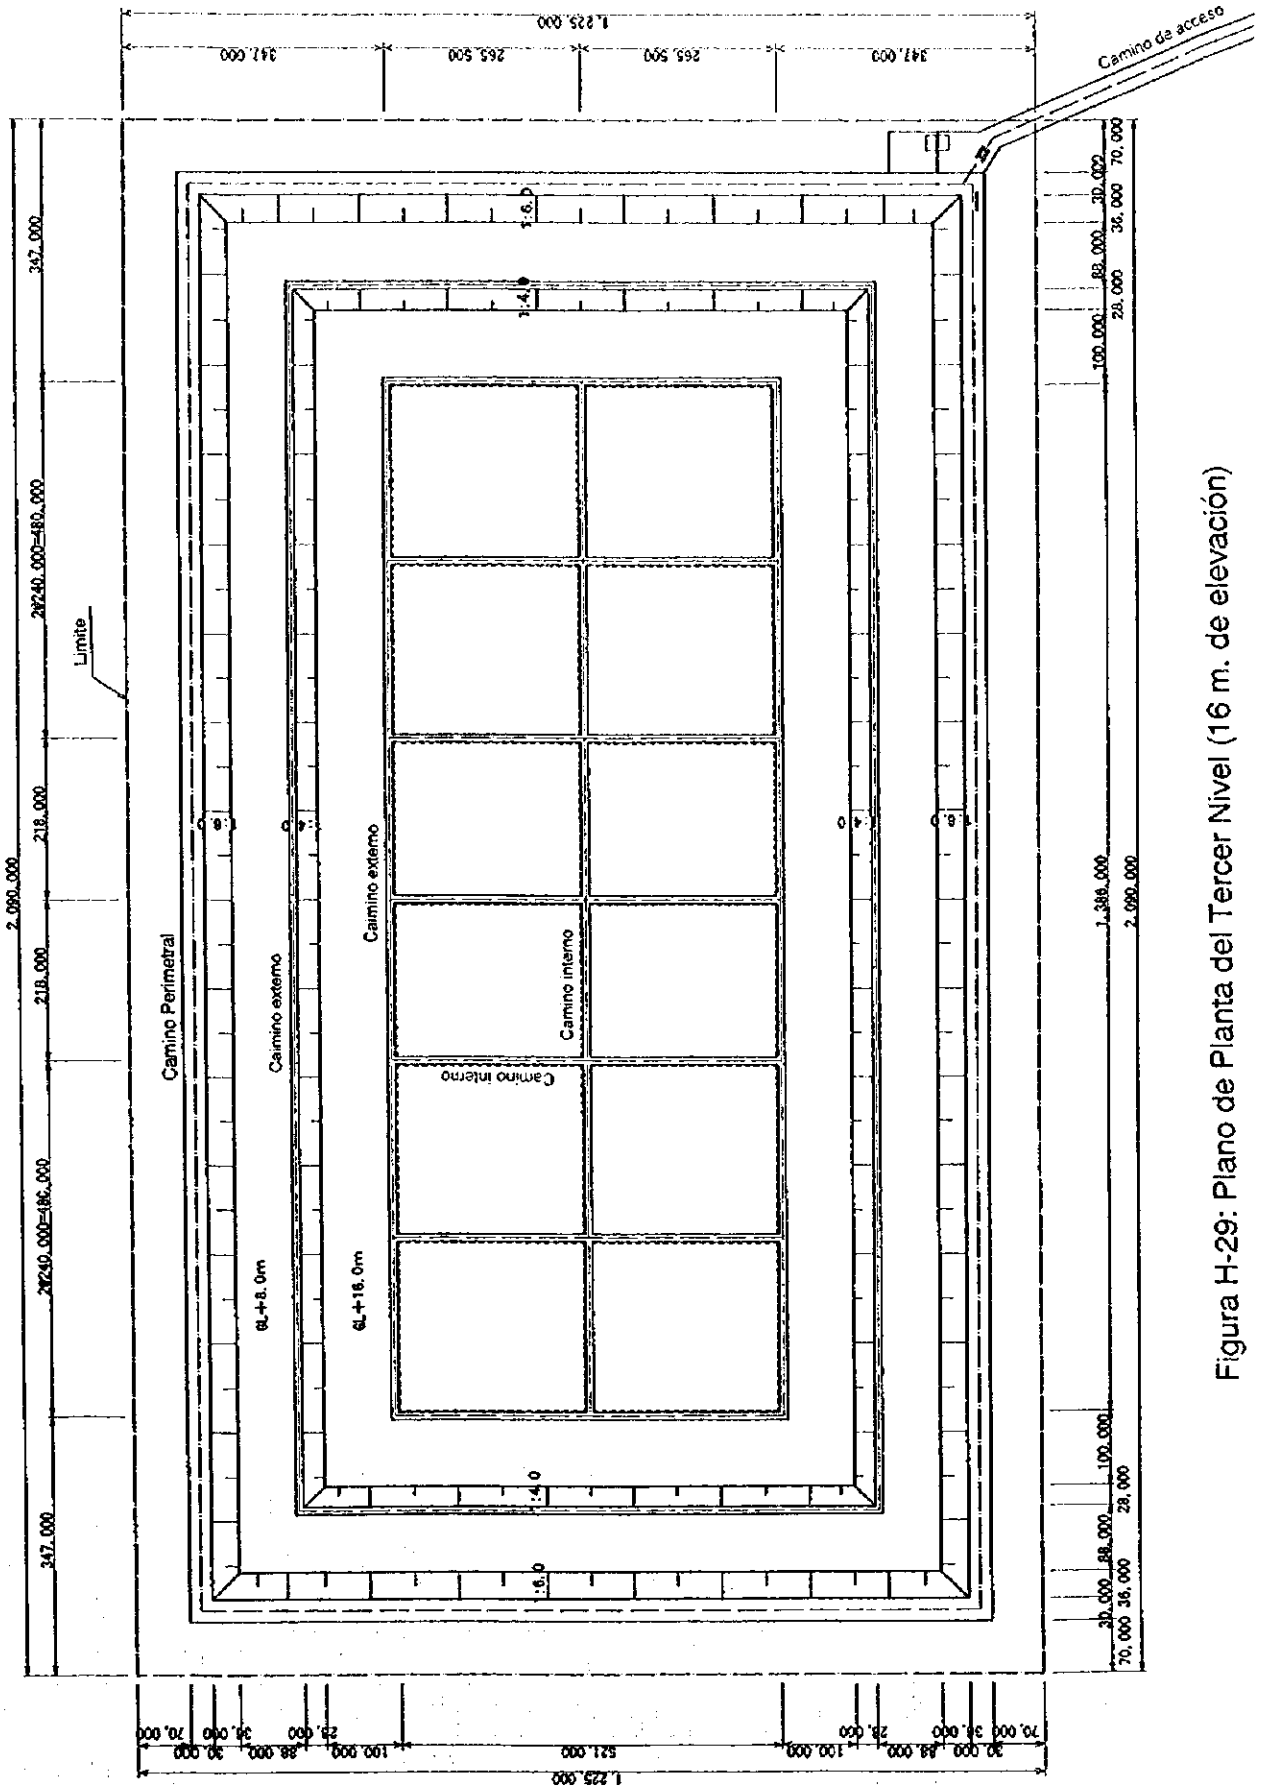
Plano de Planta del Tercer Nivel (16 m. de elevación)
